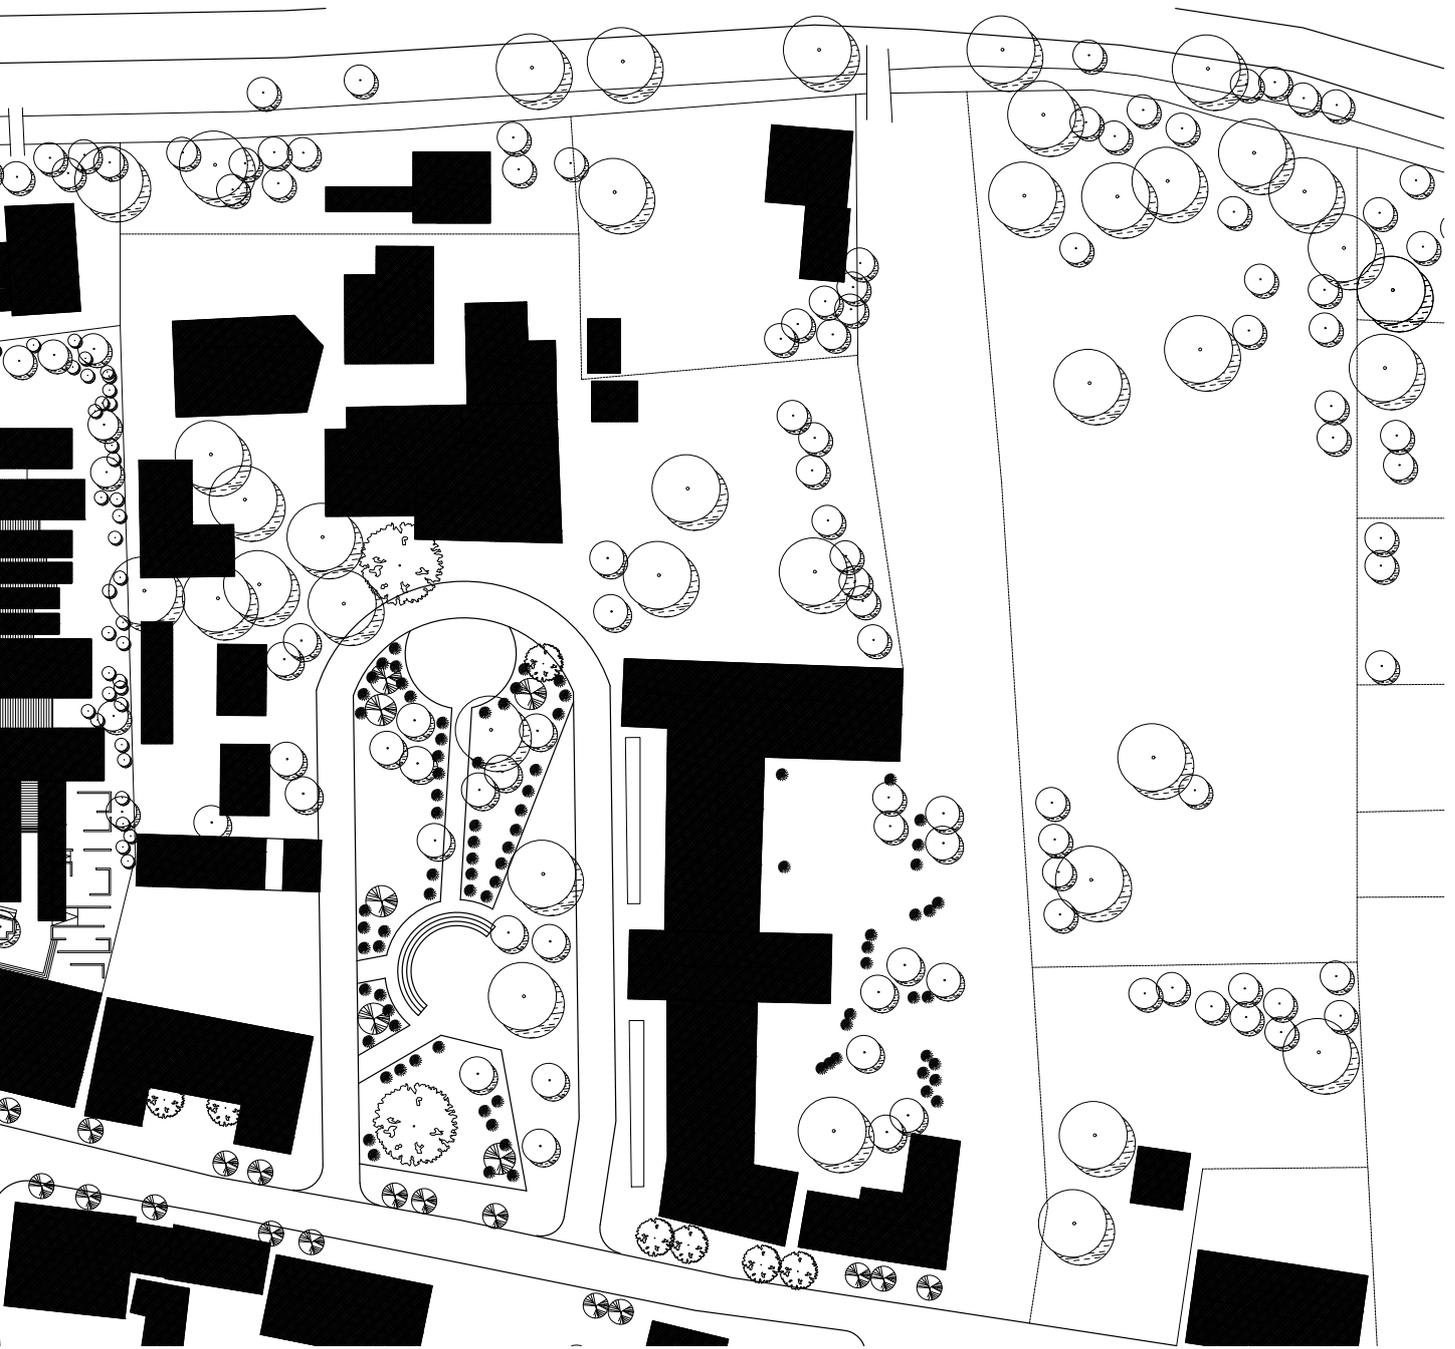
Detalle cubierta proyecto y contexto. (Elaboración propia)
